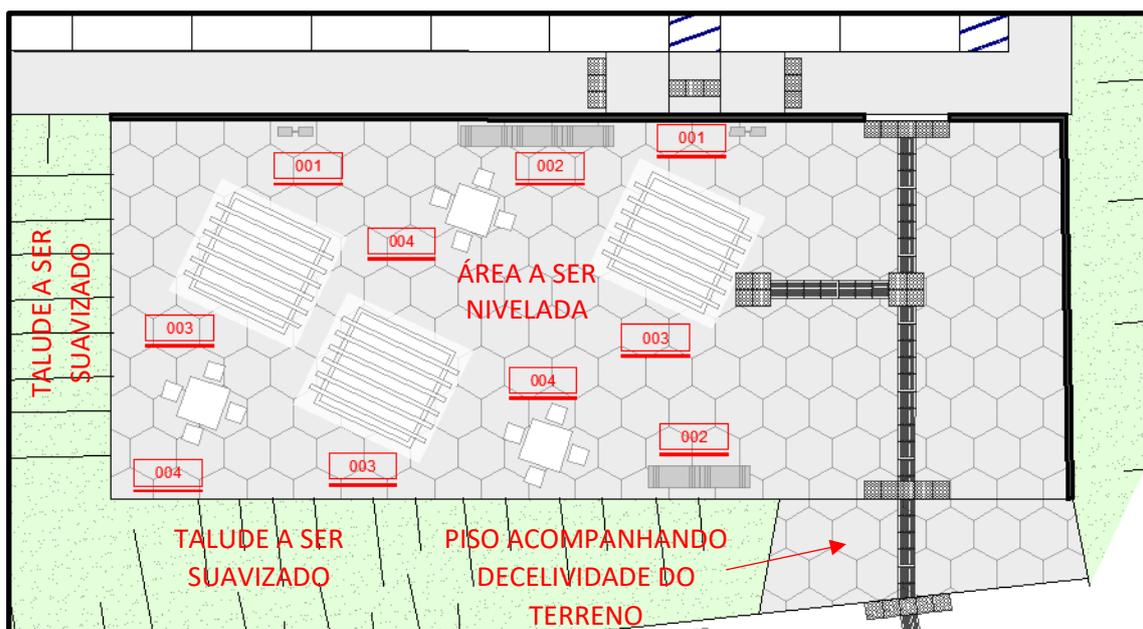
PLANTA BAIXA ÁREA DE CONVIVÊNCIA 01 – PROJETO DE ARQUITETURA
